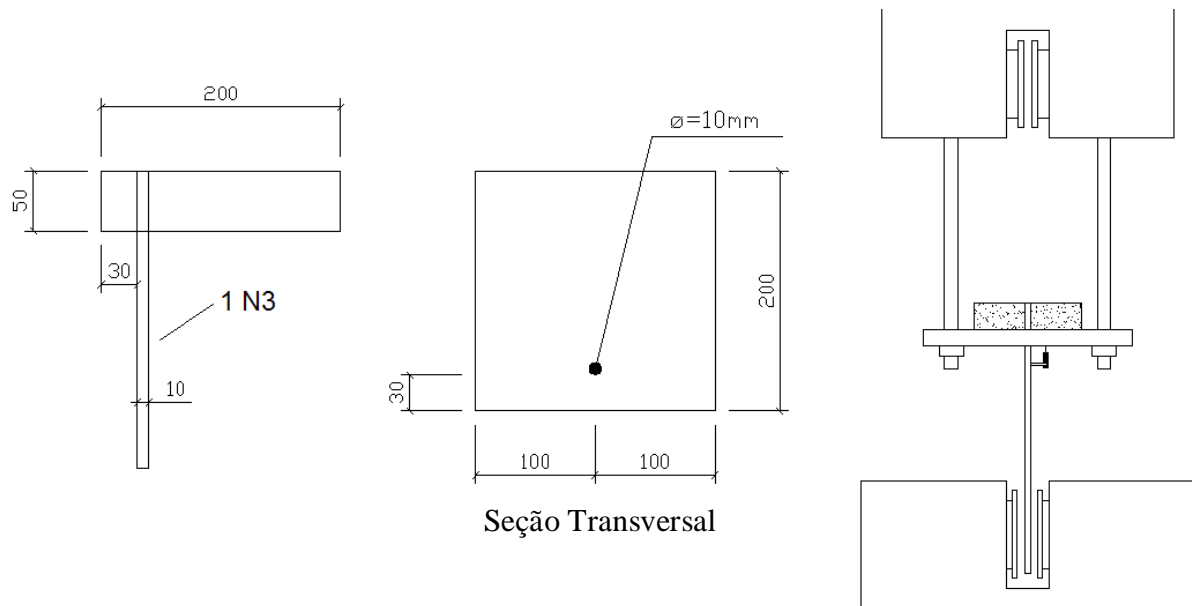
Formas do modelo de arrancamento com barras retas de 10 mm (dimensões em mm)
